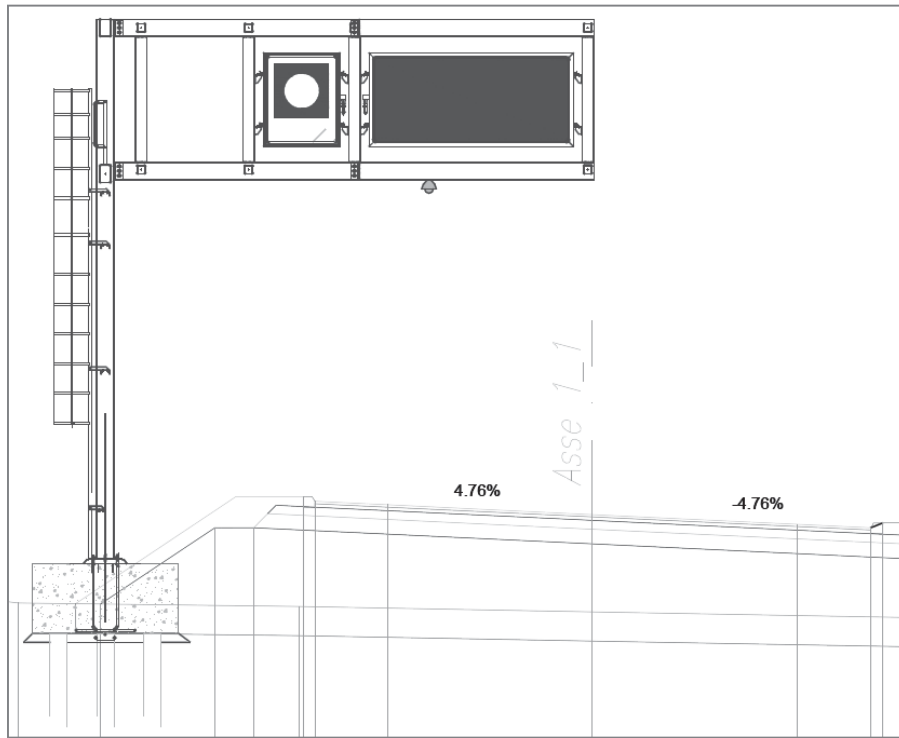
Schema del sistema PMV-fondazione – Sezione tipo lato Marche
